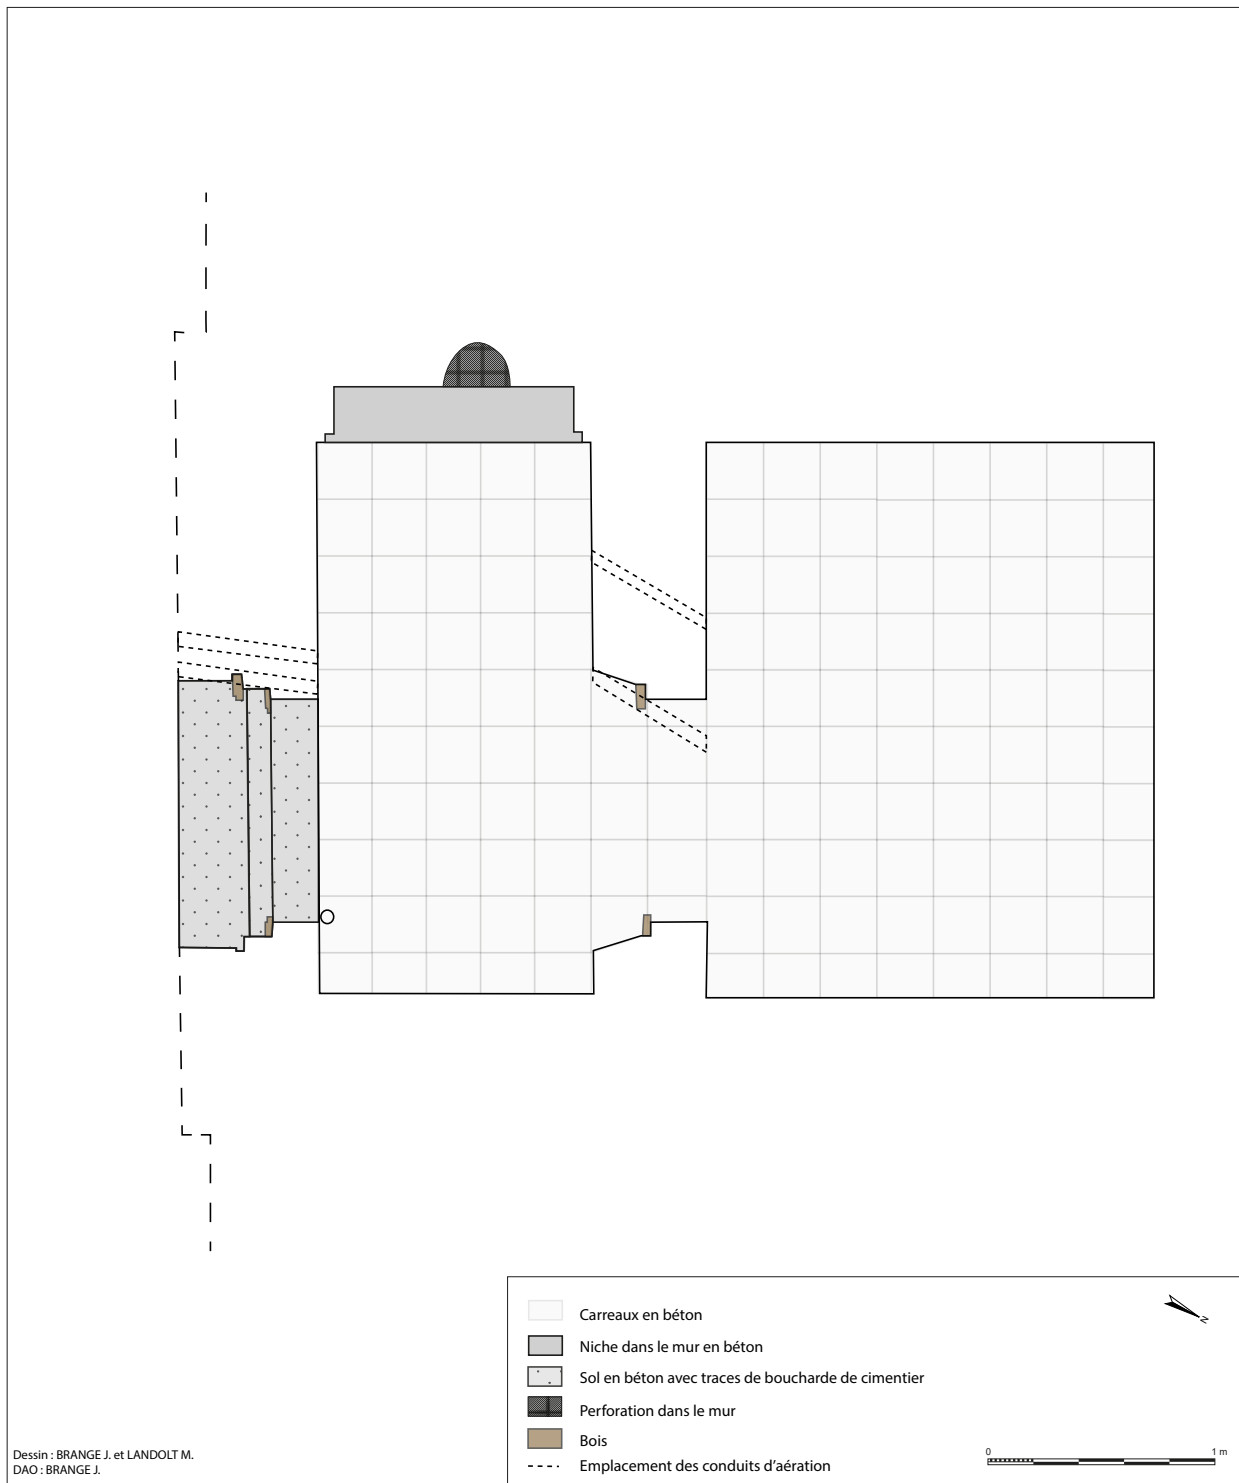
Plan de la poudrière 098 (J. Brangé).
